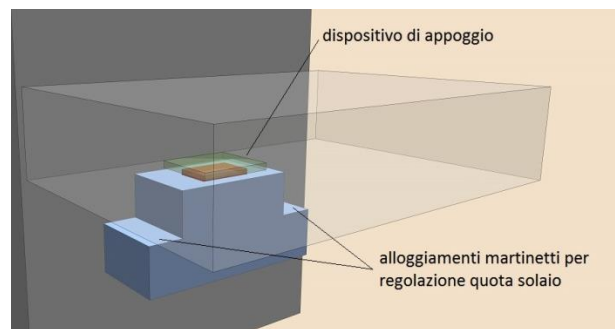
Dettaglio di regolazione della quota di appoggio dei solai
